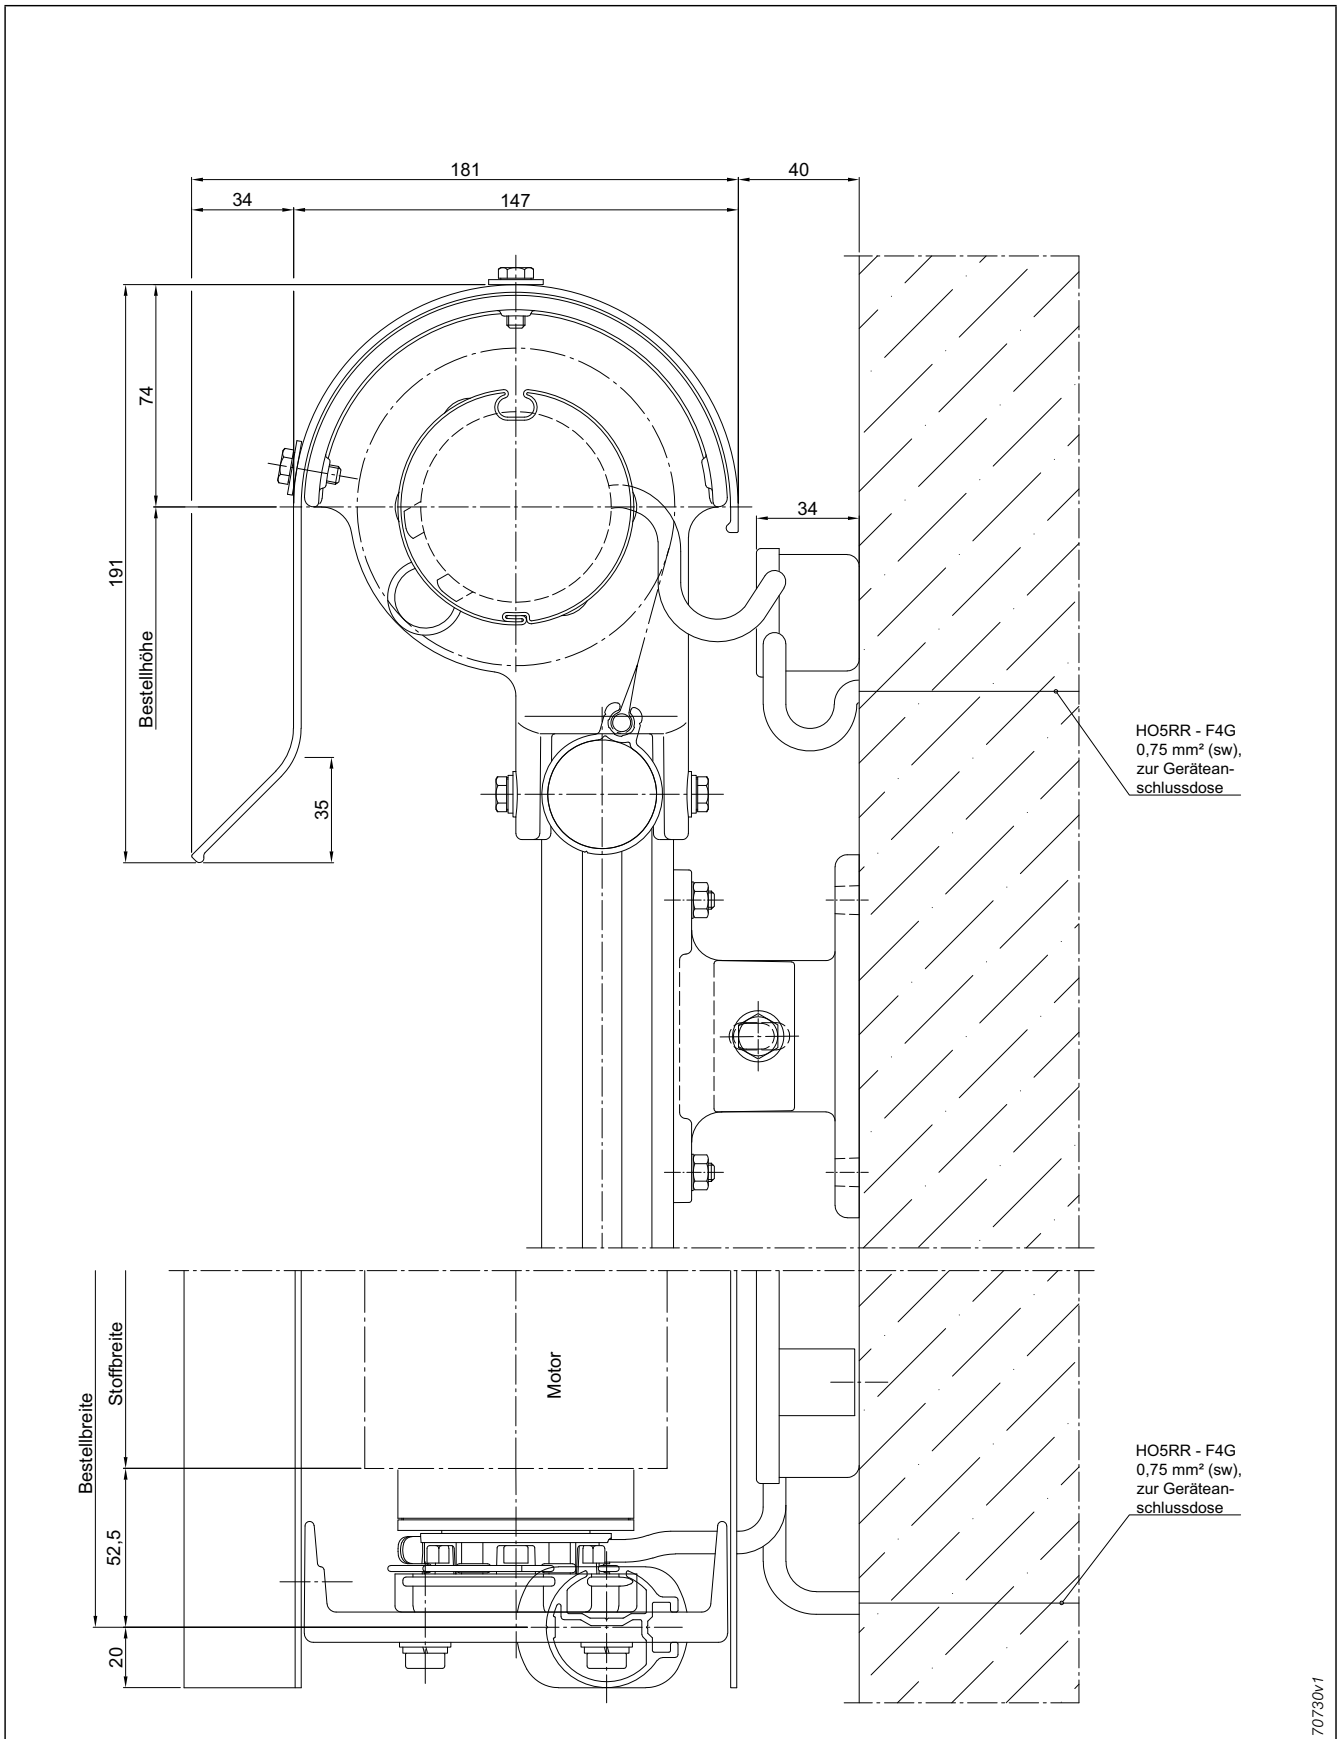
Fassaden-Markise 201 mit Halbrundblende Typ 2.3
